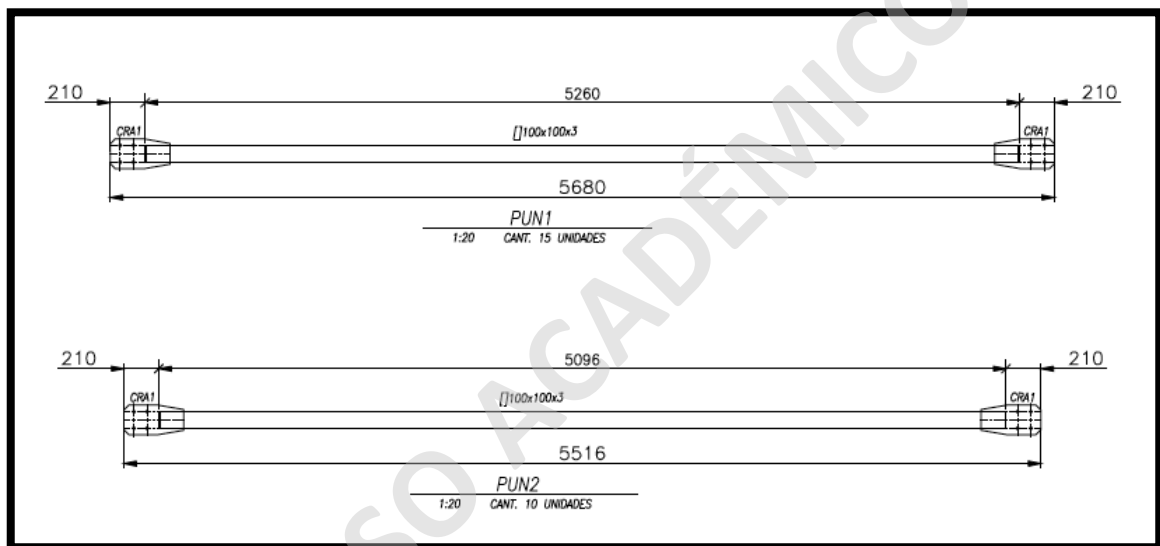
Planos de Fabricación ODR Ingeniería y Montajes
